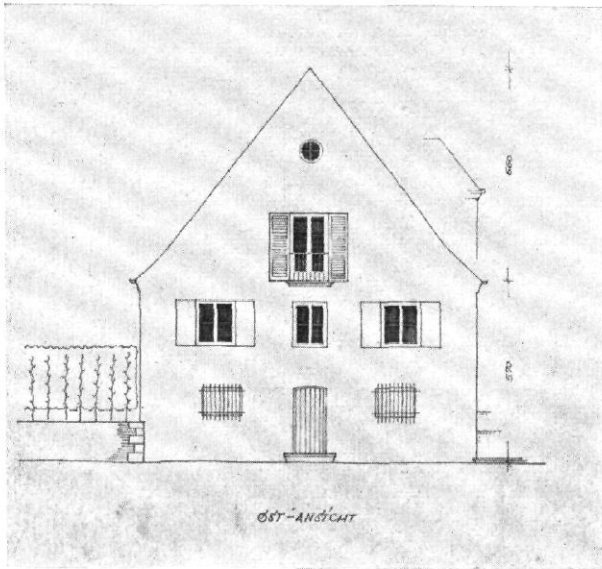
bis 96 | Ansichten und Grundrisse des Zweifamilienwohnbauses in Stuttgart (vgl. Abb. 88 und 89) | Architekt: Reg.-Baumeister Hans Seytler, Stuttgart
